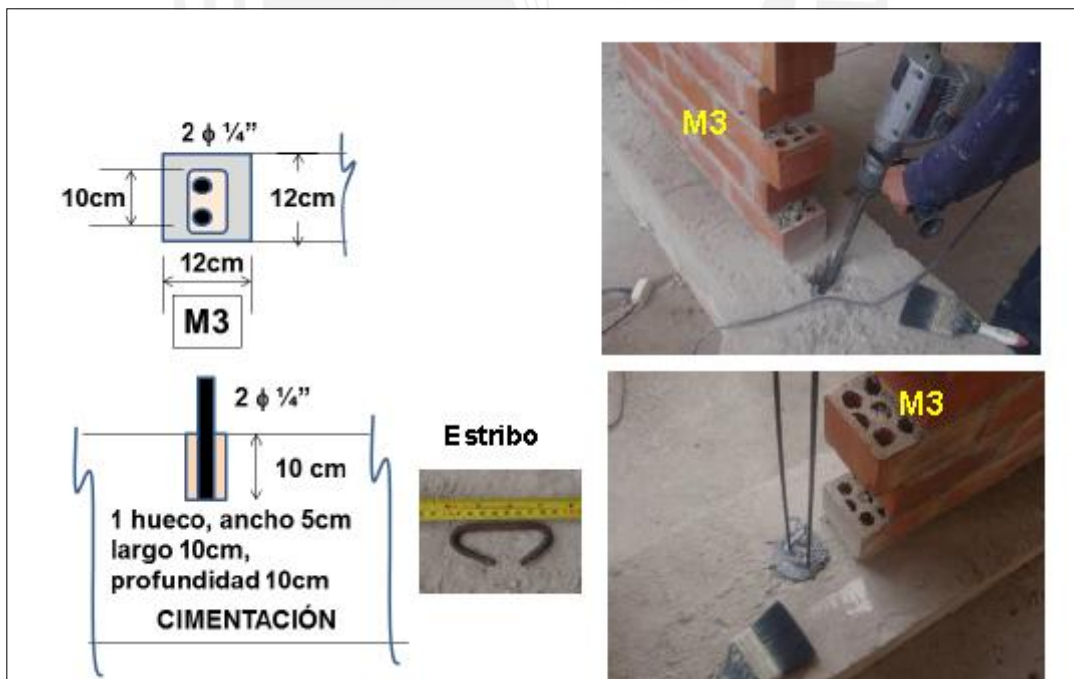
Refuerzo y anclaje en columnas del parapeto M3.
